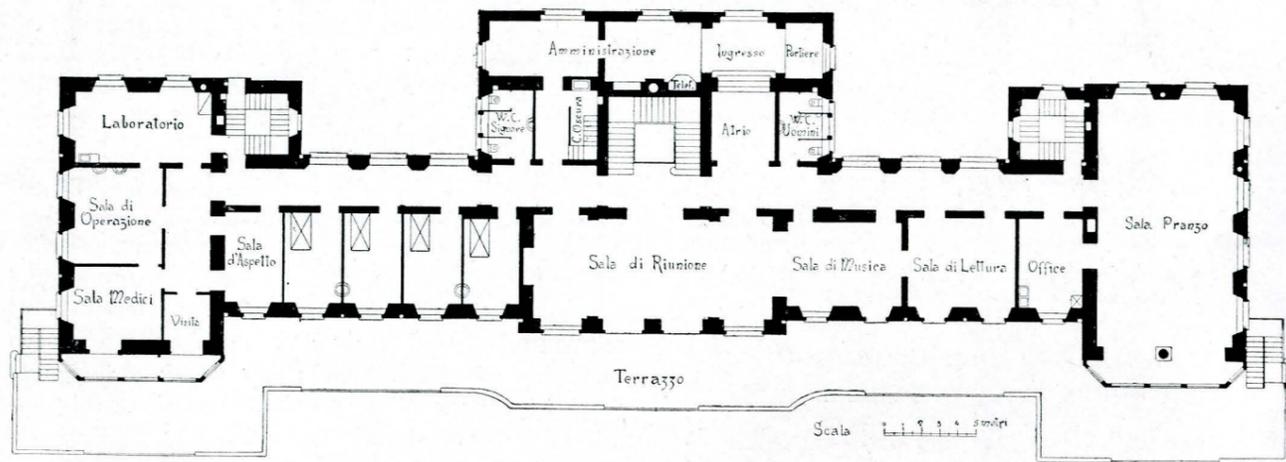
Pianta del primo piano (pianterreno a Nord).
